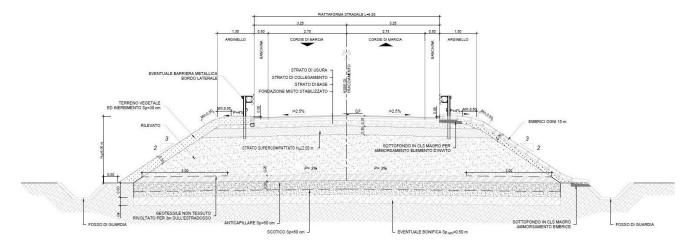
Dest. Particolare 6.5m - sezione tipo in rilevato Hril  $\leq$  6.00 m
